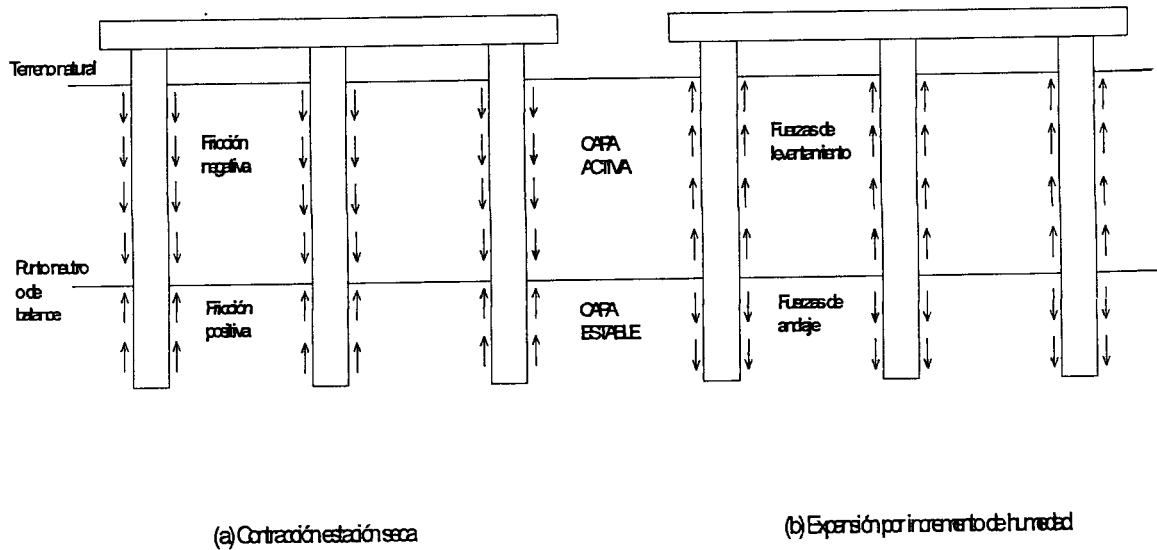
a) Pilote sometido a fricción lateral negativa. b) Pilote sometido a fuerzas de levantamiento por expansión. (Jiménez, 1977)
